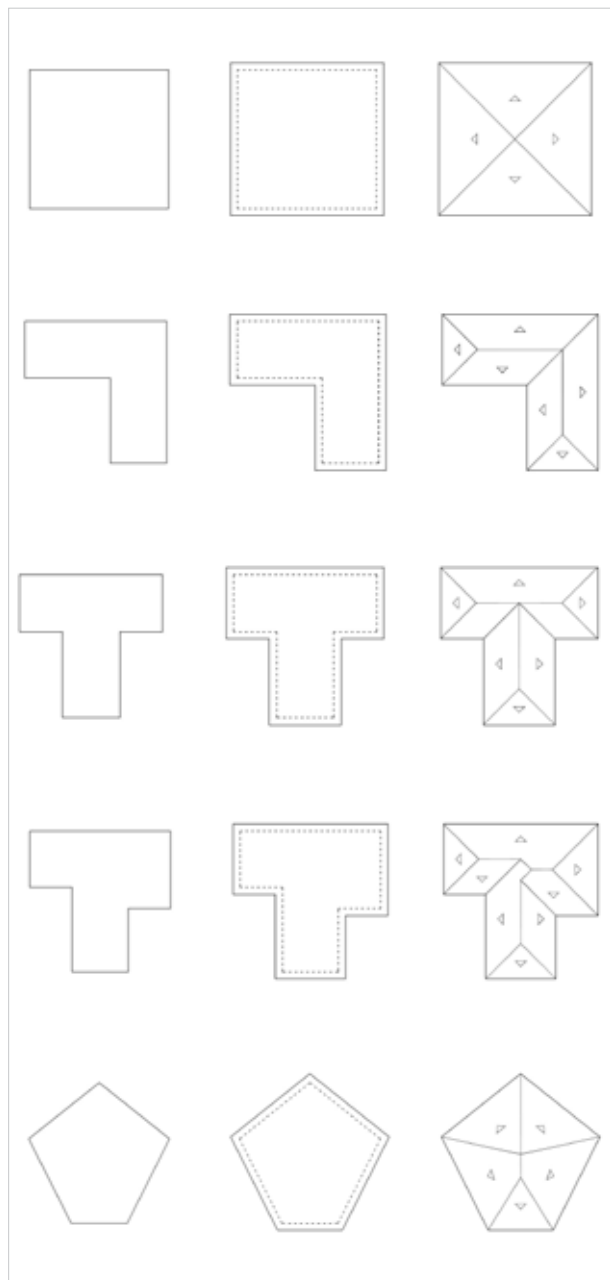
Traçados tradicionais de telhados.
